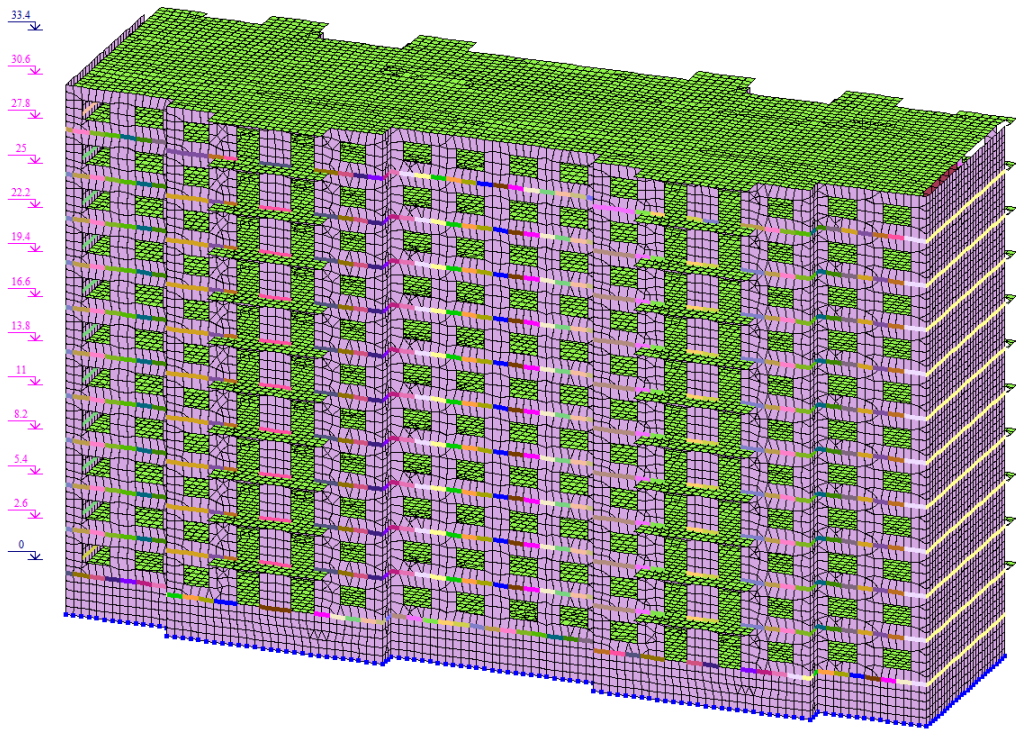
Скінченно-елементна модель будівлі: ■ – СЕ плит перекриття; ■ – СЕ стін з бетонних блоків
